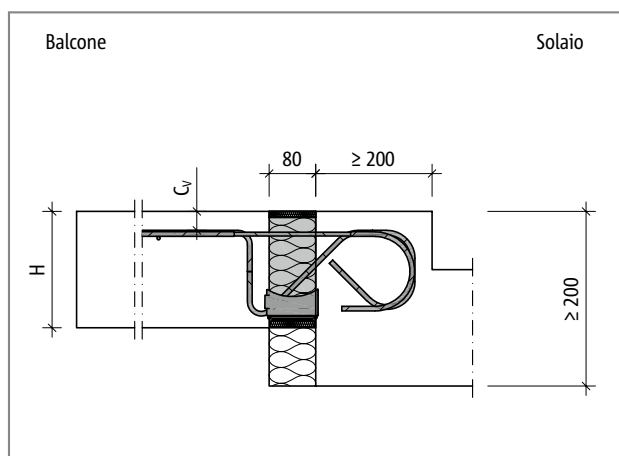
Schöck Isokorb® T tipo KL-O-M1 - KL-O-M7: balcone con innalzamento e isolamento esterno
